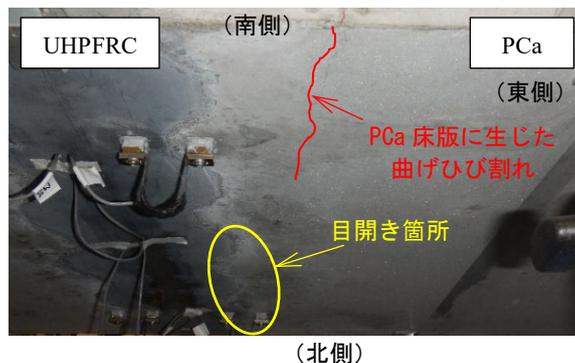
繰返し载荷後のひび割れ発生状況 (東側界面付近, 下面)
